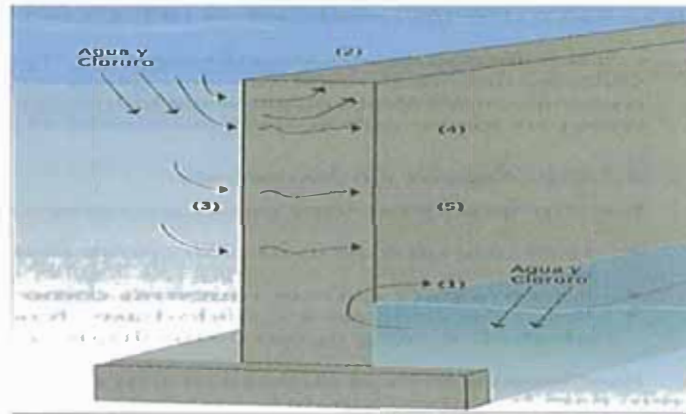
Corrosión en la columna de concreto de pila
